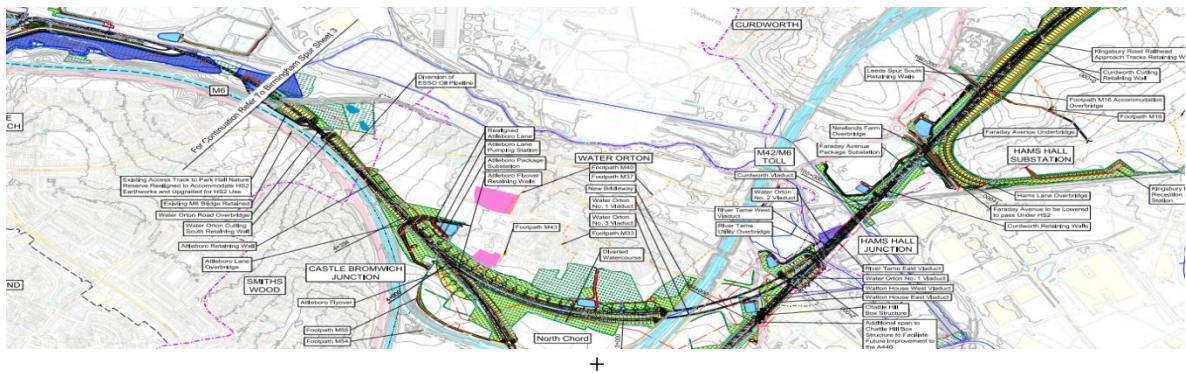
Planta do traçado do viaduto No.1 de Water Orton (Unido, North Chord).
